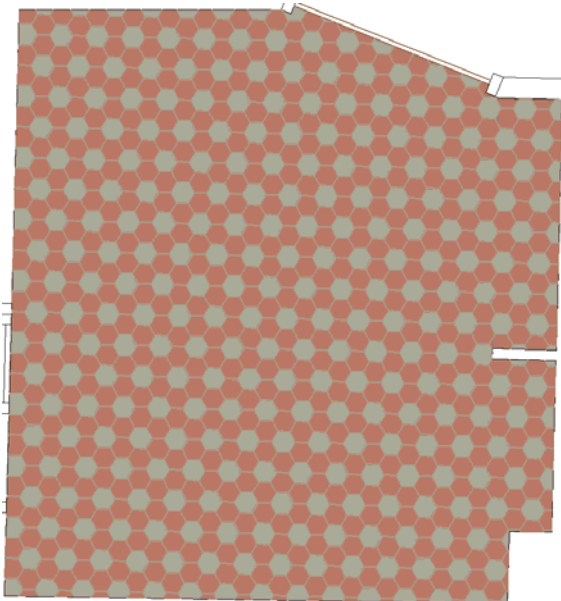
Levantamiento gráfico pavimento. Fuente propia.
